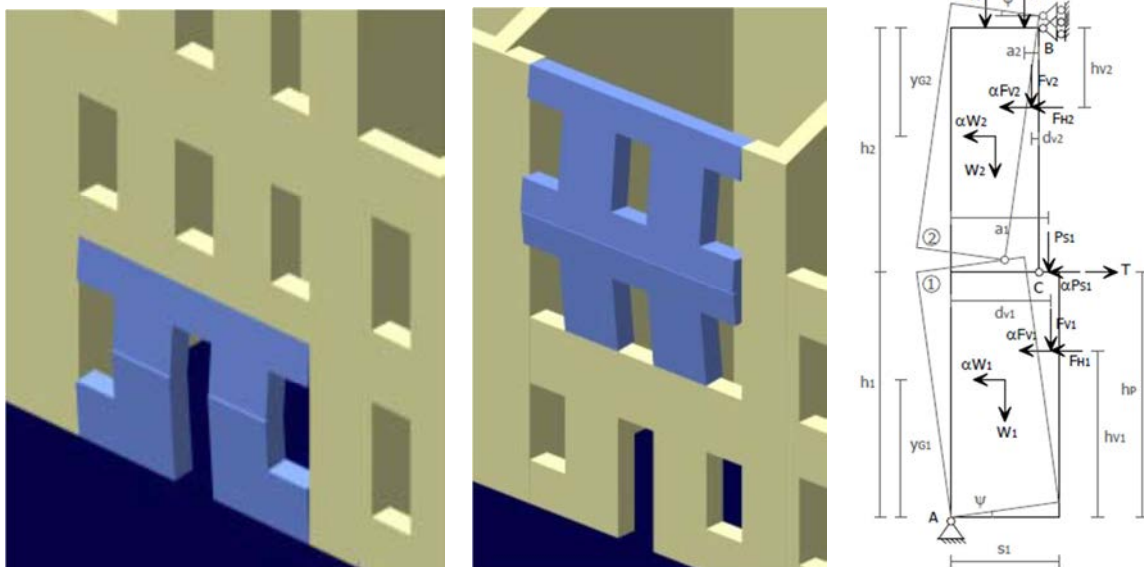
Meccanismo 3: flessione verticale di parete considerato un singolo piano o due piani distinti e relativa schematizzazione.
